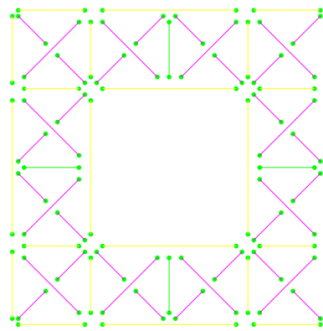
a Planta de piso “tipo”, incluyendo la disposición de los arrostramientos de piso con posición y conectividad [elaboración propia]
